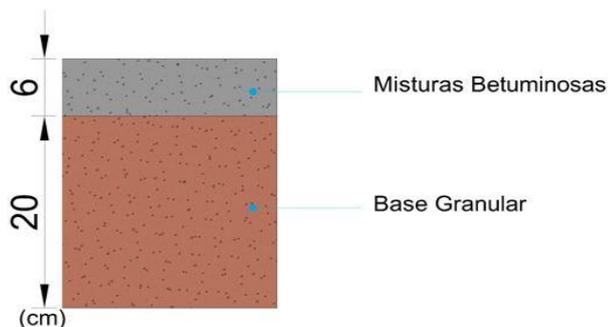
Estrutura do pavimento existente antes da execução dos trabalhos de reabilitação
